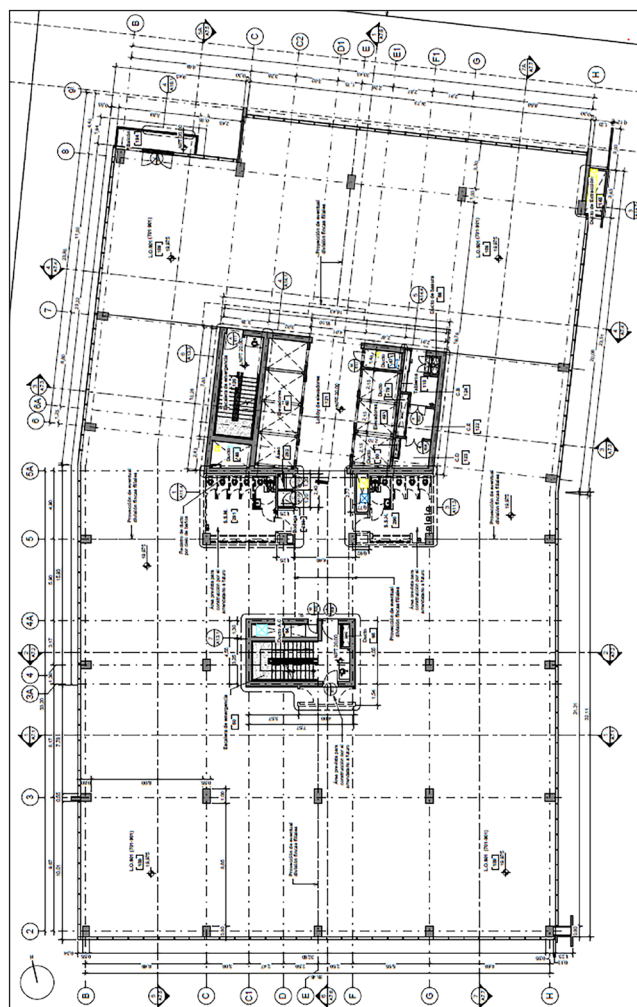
Planta Arquitectónica niveles 6, 7 y 9 del edificio SPBC.
